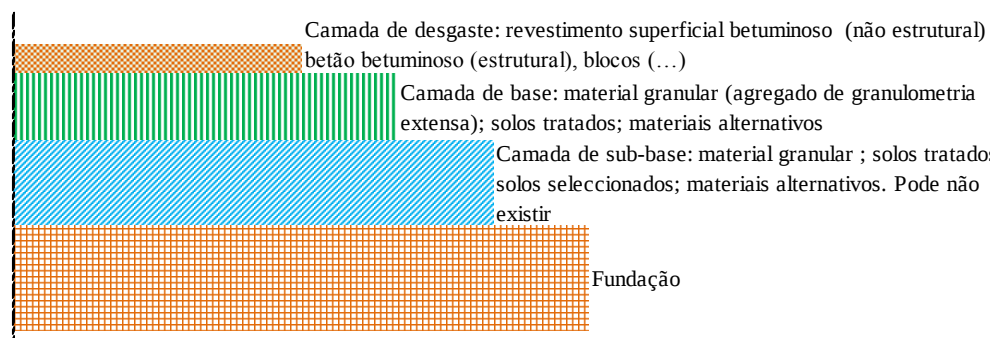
Estrutura do pavimento de estradas revestidas (adaptado de Fortunato et al, 2013)
